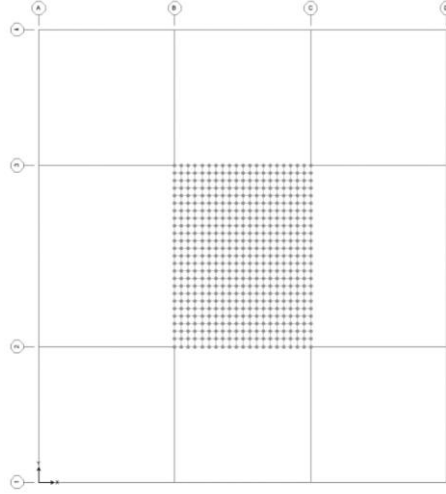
2 : Plak ve zemin plan gösterimi.
